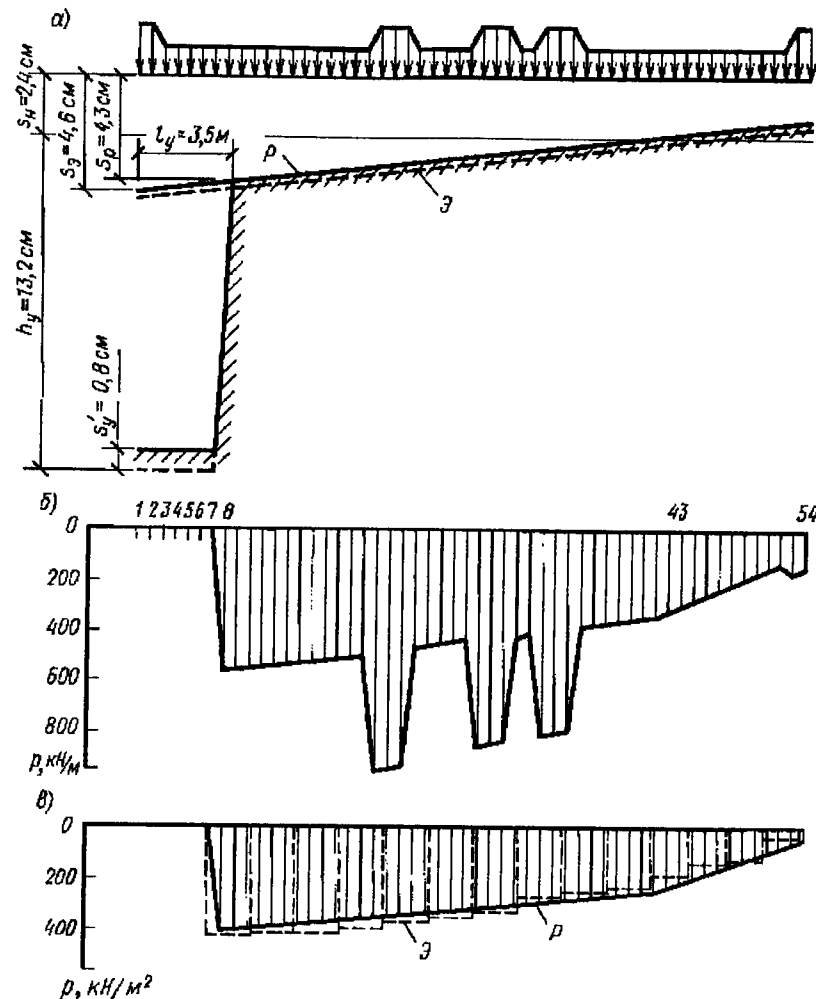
Взаимодействие продольной наружной стены со ступенчато оседающим основанием:
